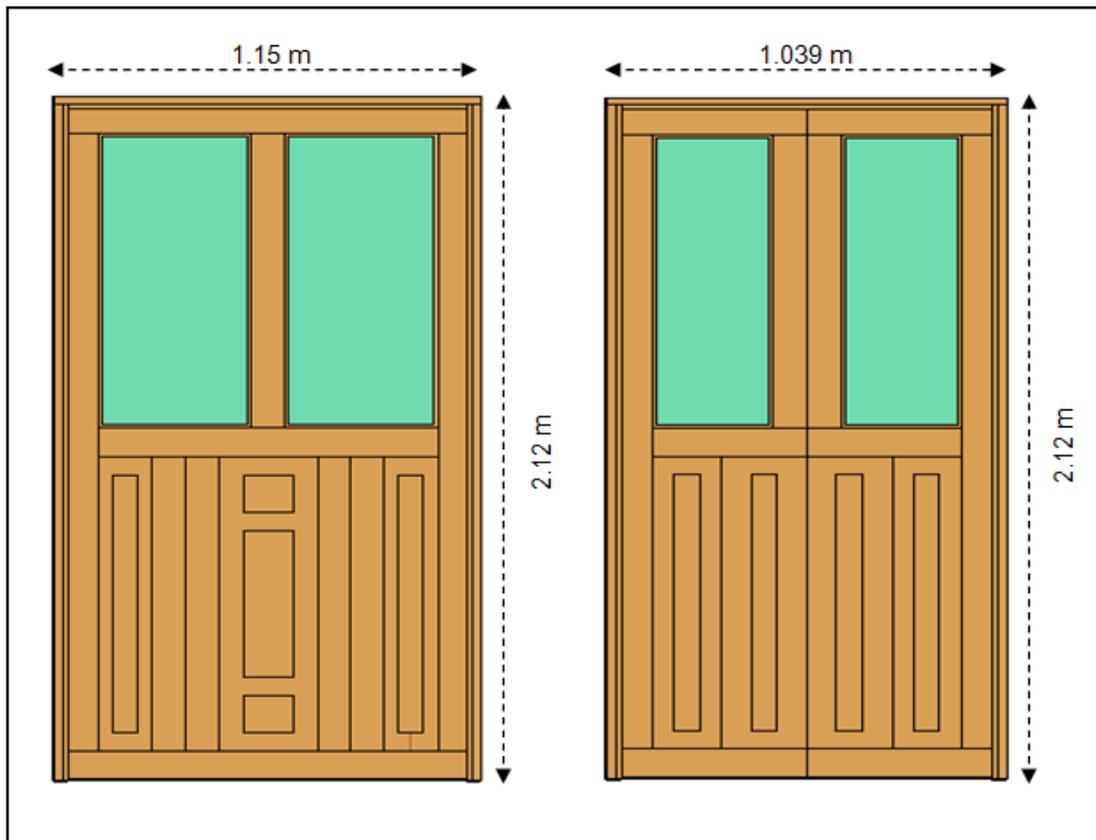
Vista frontal de la puerta principal (izquierda) y trasera tipo “dos hojas” (derecha).
